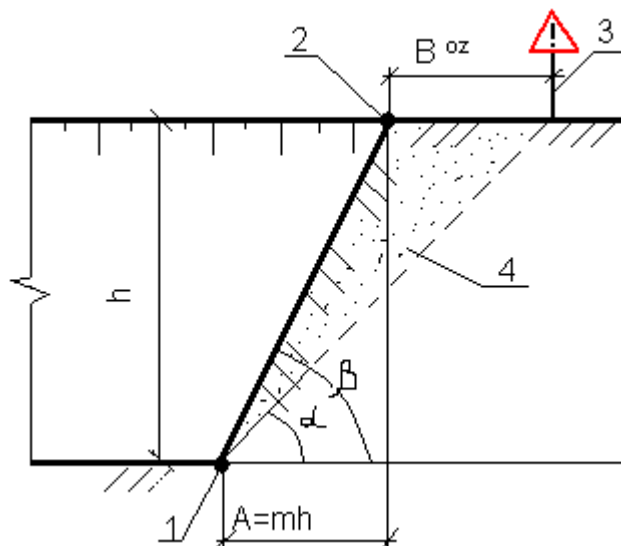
Граница опасной зоны обрушения: 1-нижняя бровка выемки; 2- верхняя бровка выемки; 3-граница опасной зоны; 4-призма обрушения; α - угол естественного откоса грунта; β - угол откоса выемки
